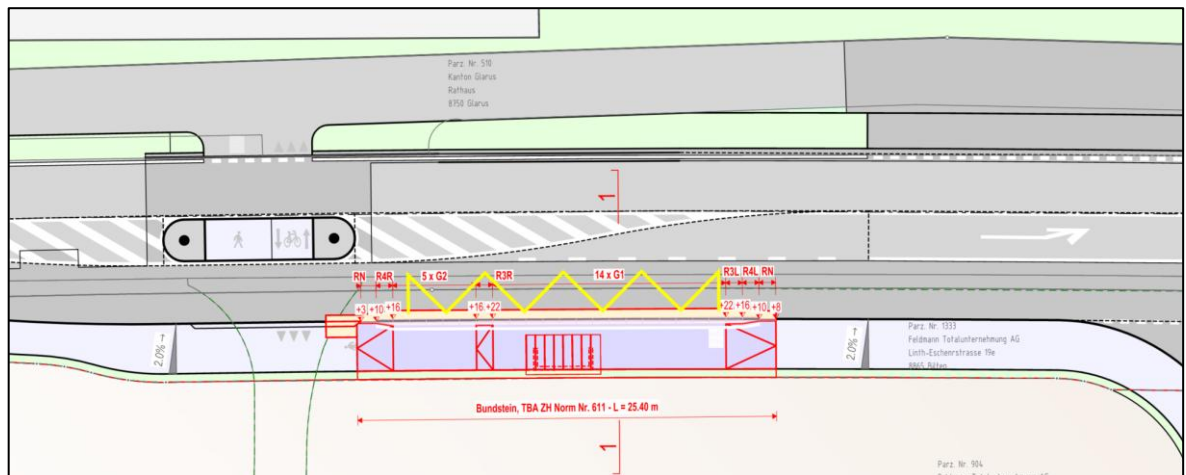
Ausschnitt Lage der Bushaltestelle aus Situationsplan
